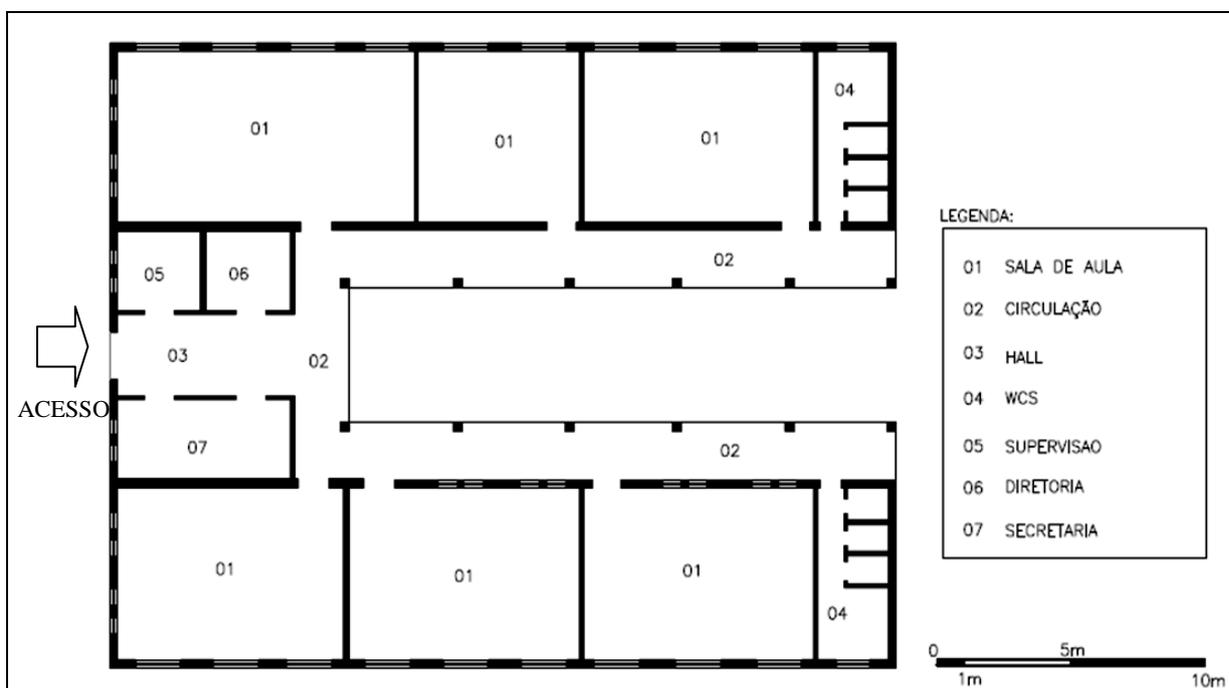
Possível planta baixa original do ex-Grupo Escolar de Quixadá (1937)
